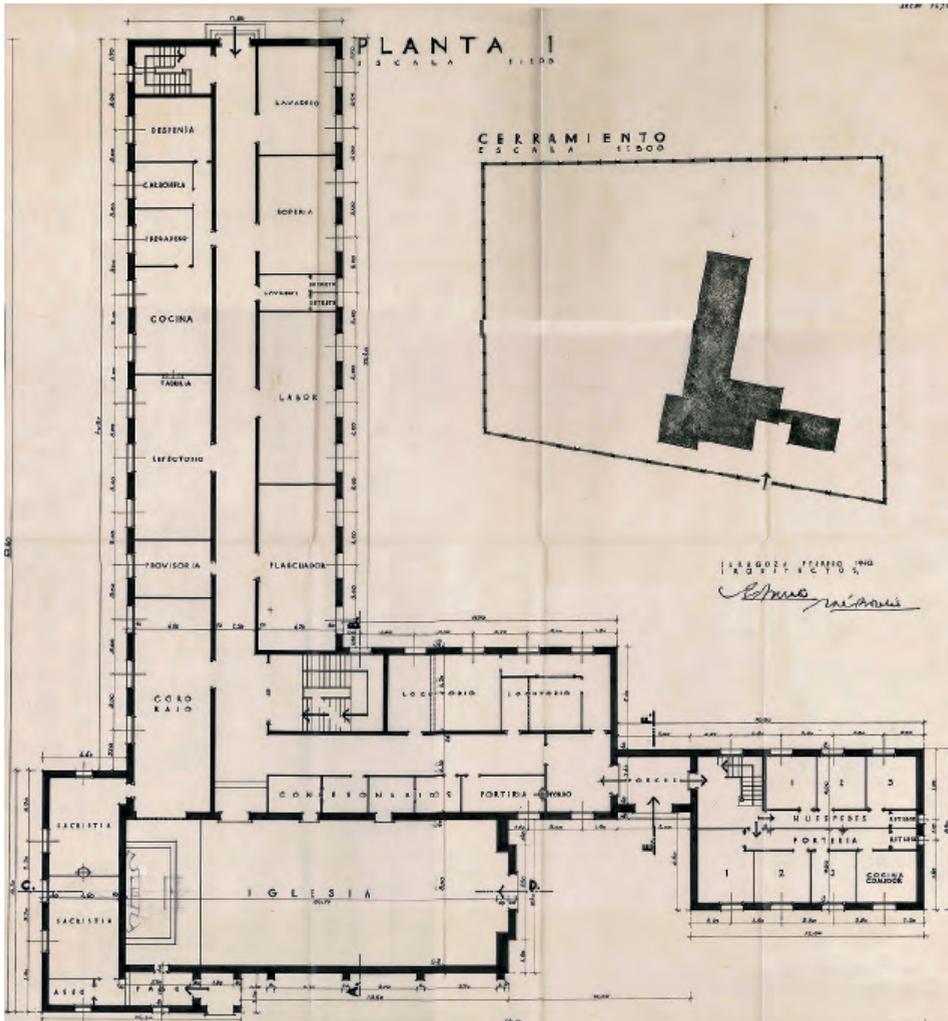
Plano. Planta 1 del convento de Santa María de Jerusalén, por los arquitectos Regino y José Borobio Ojeda (ABAU).
